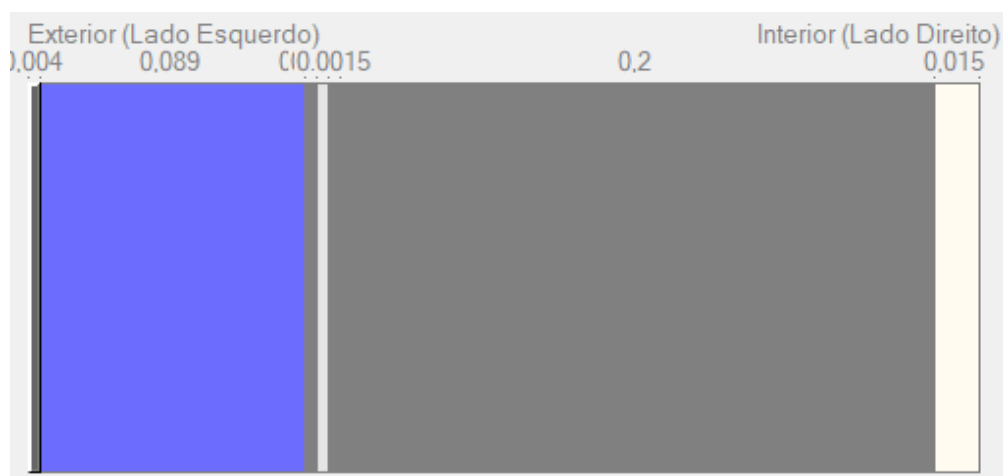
Esquema construtivo da cobertura plana 4
